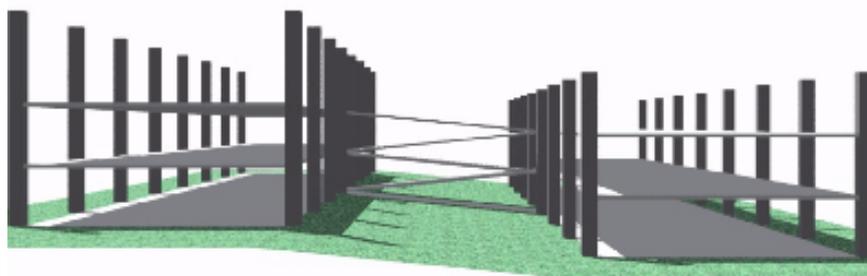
Vista da Estrutura (Lajes, vigas e pilares)
